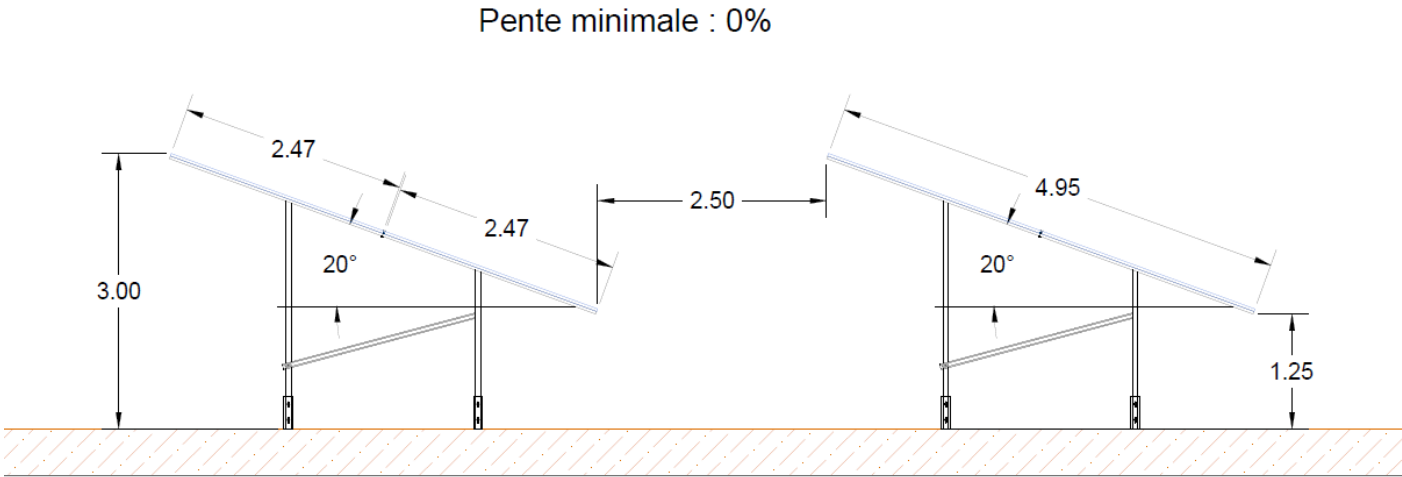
Coupe des structures porteuses prévues sur la partie plane du site d'Armous-et-Cau (Source : CORFU Solaire)
